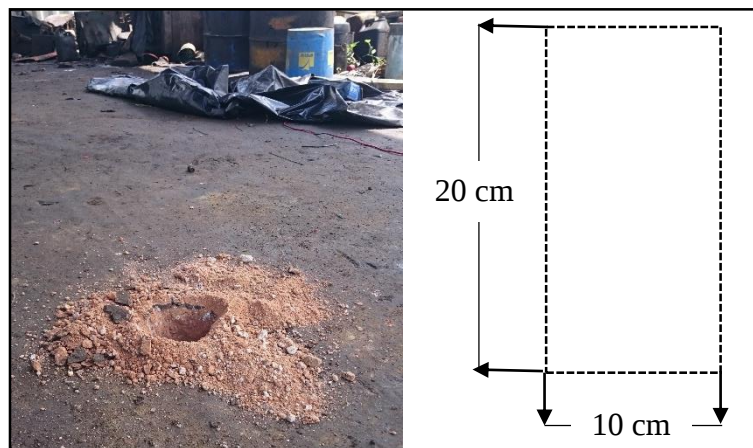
Dimensión del agujero en el punto N° 1; Taller B
